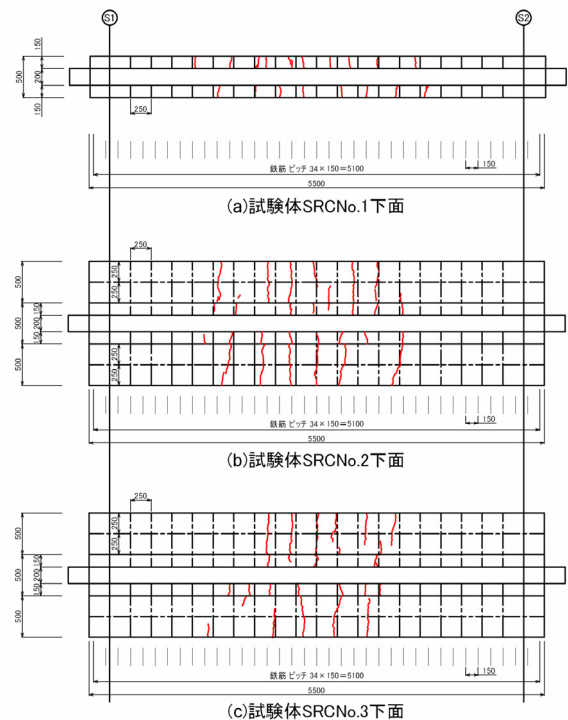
ひび割れ図(ひび割れ進展時-300kN)
